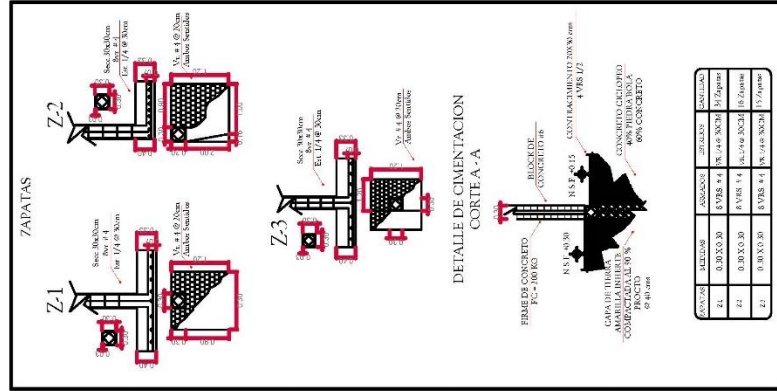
Plano de Estructuras – Cimentación del Museo “Cristo Redentor”
